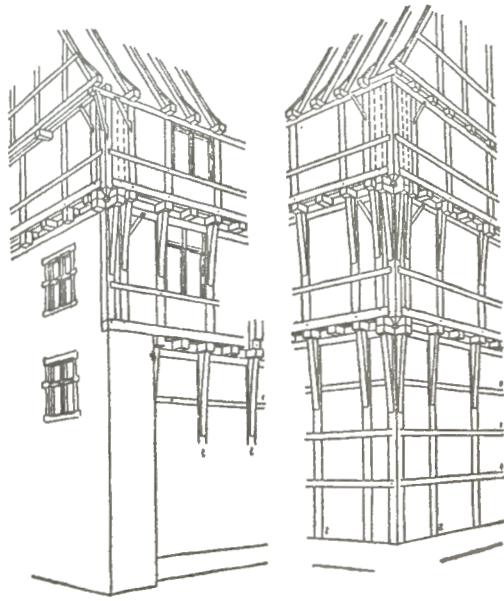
Gießen, Leib'sches Haus, Südwestecke und Südostecke (nach Walbe).
